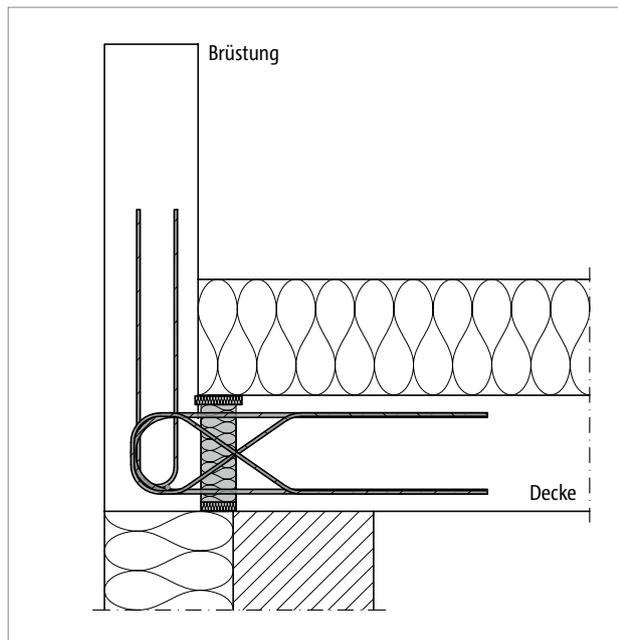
Schöck Isokorb® T Typ F: Anschluss einer frontal angeschlossenen Brüstung mit Wärmedämmverbundsystem
